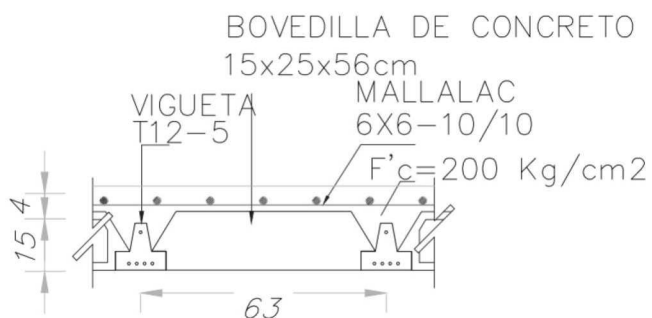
Detalle de armado de losa sistema de vigueta y bovedilla
